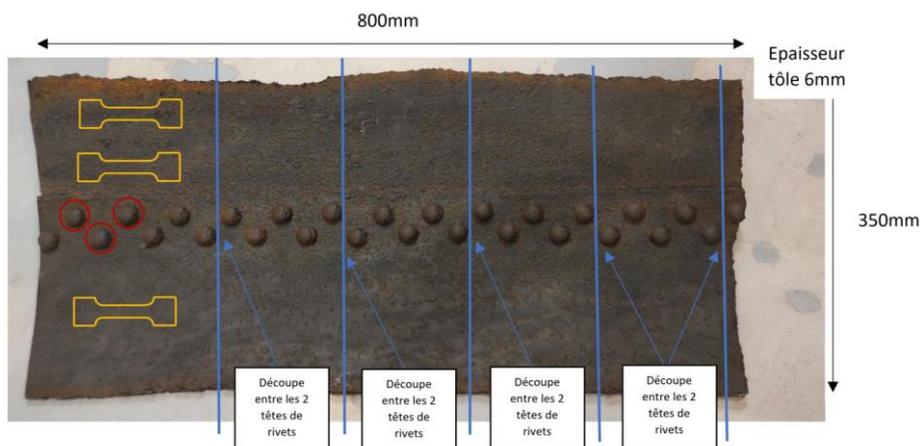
Echantillons Conduite Forcée - assemblage longitudinal
